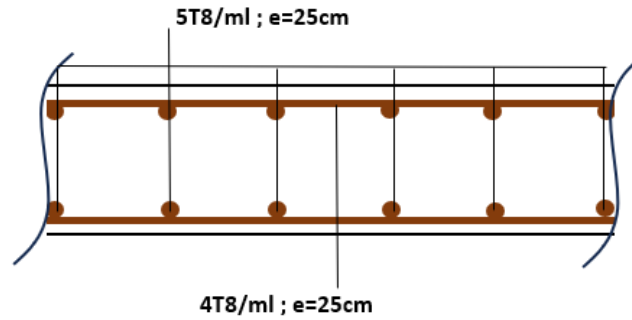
vue en plan d'un coup de ferrailage de l'acrotère.
